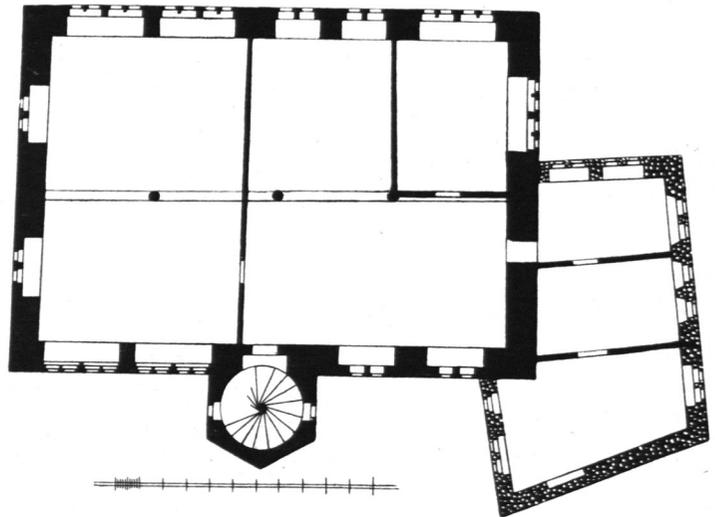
Rathaus zu Marburg. Grundriß des ersten Stockwerks. Nach Aufnahme des Stadtbauamtes.
